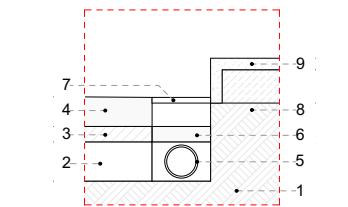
Planta y elevación en sección constructiva 04. Elaborado por: El autor.
